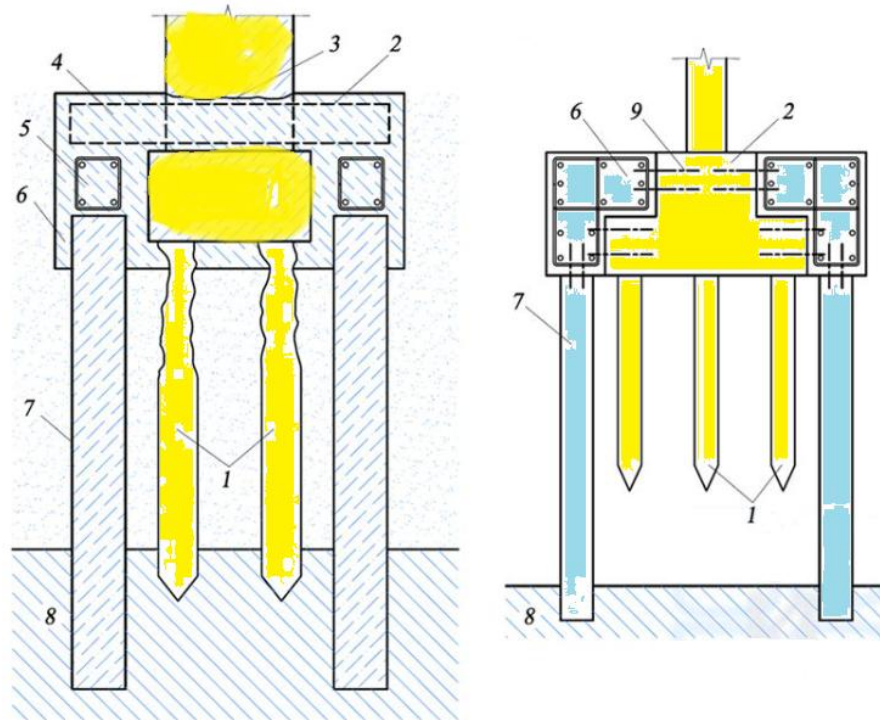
Підсилення фундаменту пальово-каркасною конструкцією: 1 – збірна залізобетонна паля; 2 - підсилений фундамент; 3 – отвір; 4 – ригель; 5 – каркас; 6 – монолітна в'язка паль; 7 – палі підсилення; 8 – несучий ґрунт
